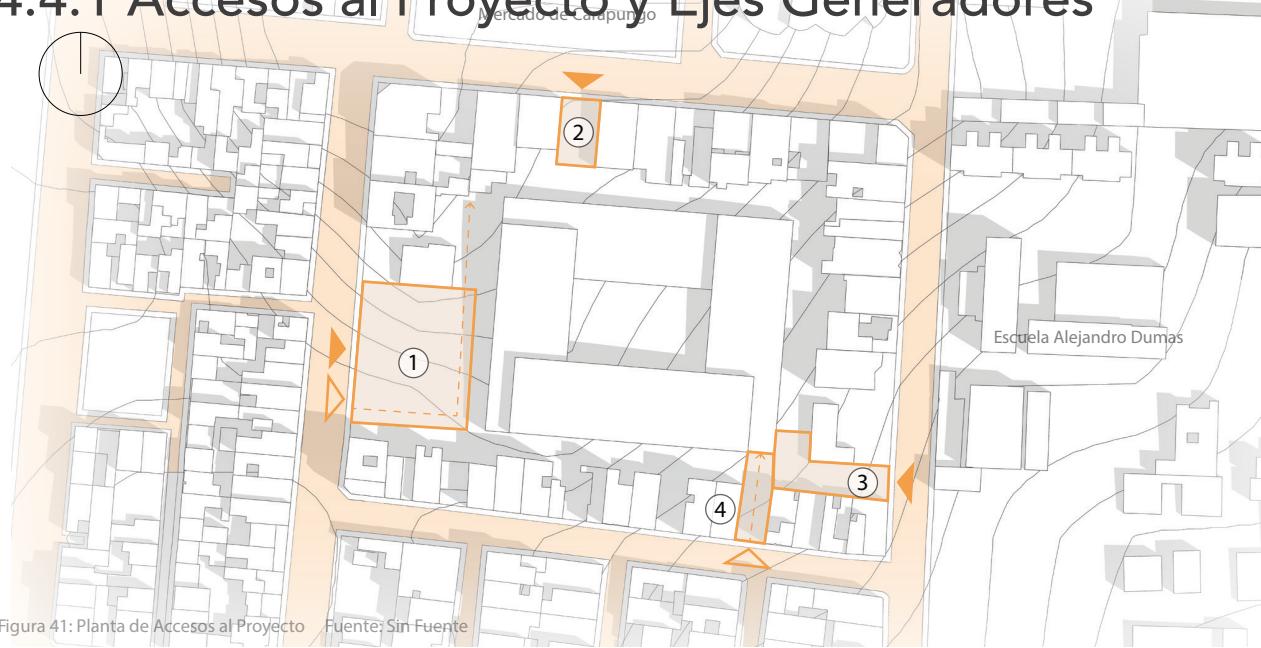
Planta de Accesos al Proyecto Fuente: Sin Fuente
